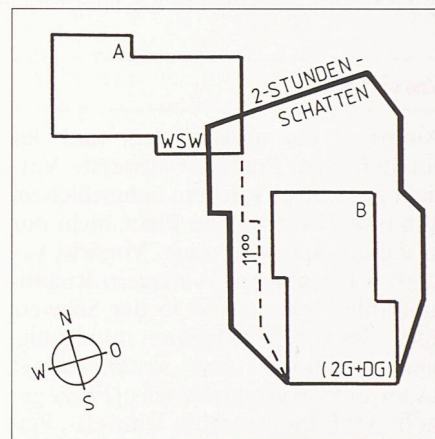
Die Westsüdwest-Fassade des Gebäudes A liegt teilweise innerhalb der 2-Stunden-Schattengrenze von Gebäude B. Die Fassade des Gebäudes A wird jedoch ab 11.00 bis fast 16.00 Uhr sehr gut besonnt. (Aus bewilligtem Gestaltungsplan für Lenzburg.)
